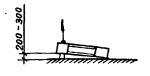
Схема отрыва ФЕРМЫ ОТ ПОДДОНА
